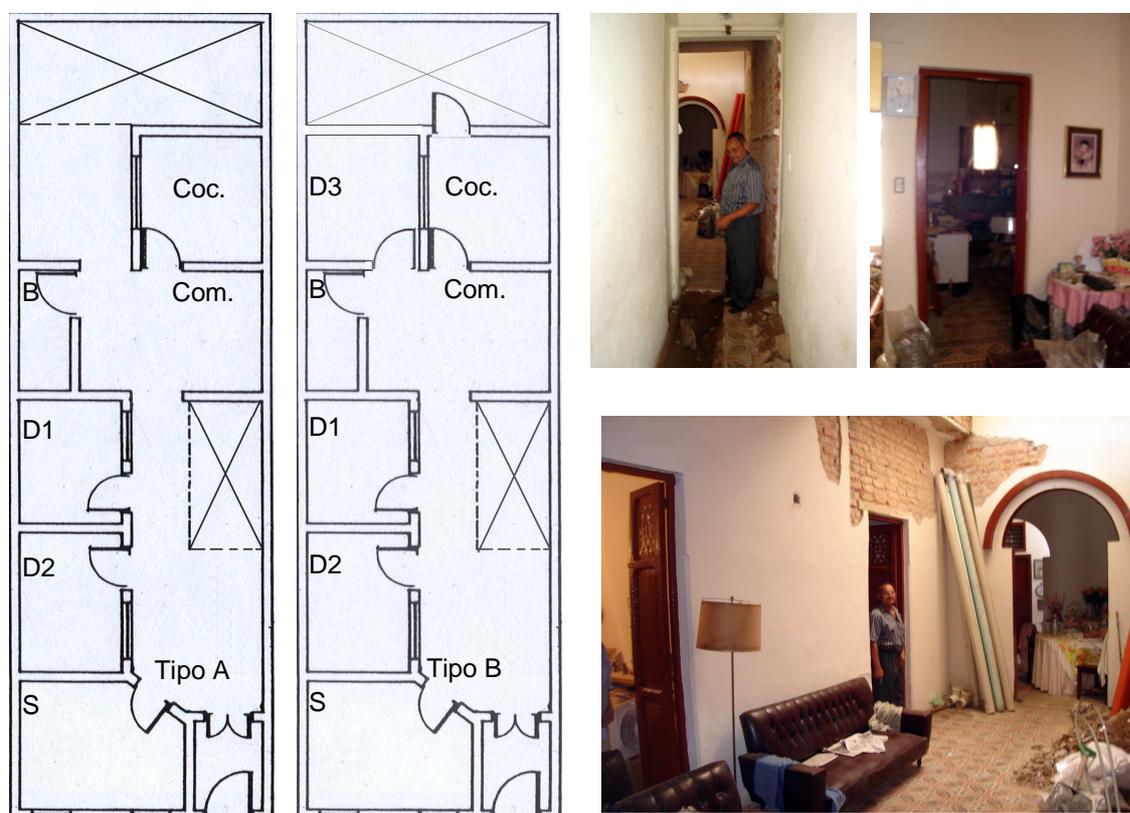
Interior de viviendas Tipos "A" y "B" en San Agustín del Sur.
